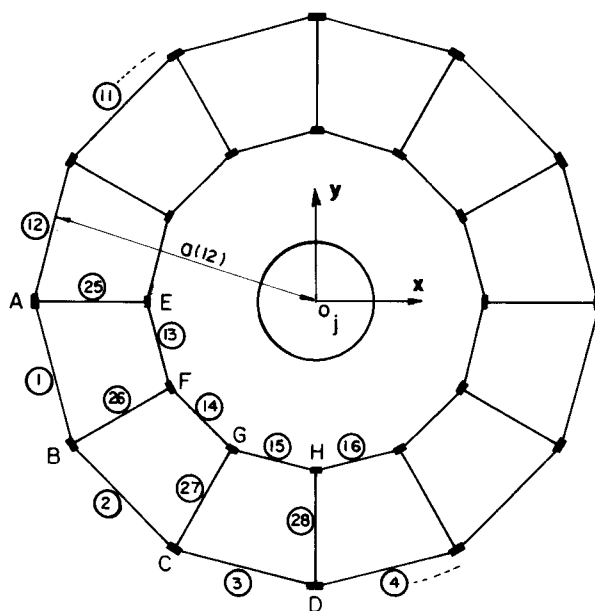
o) PLANTA DA ESTRUTURA DO EDIFÍCIO
